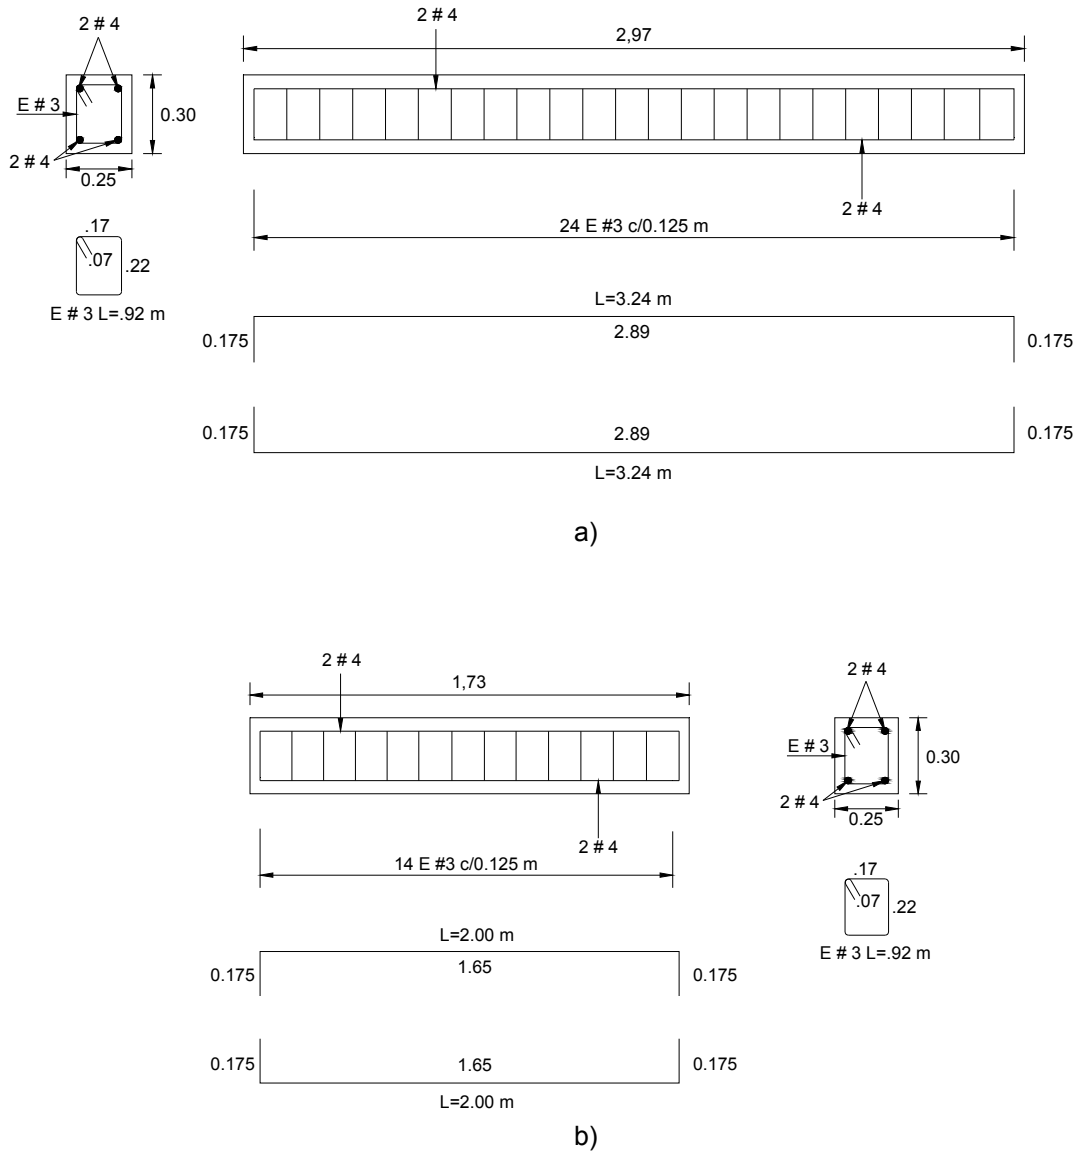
Dimensiones y refuerzo de las vigas de cimentación.
